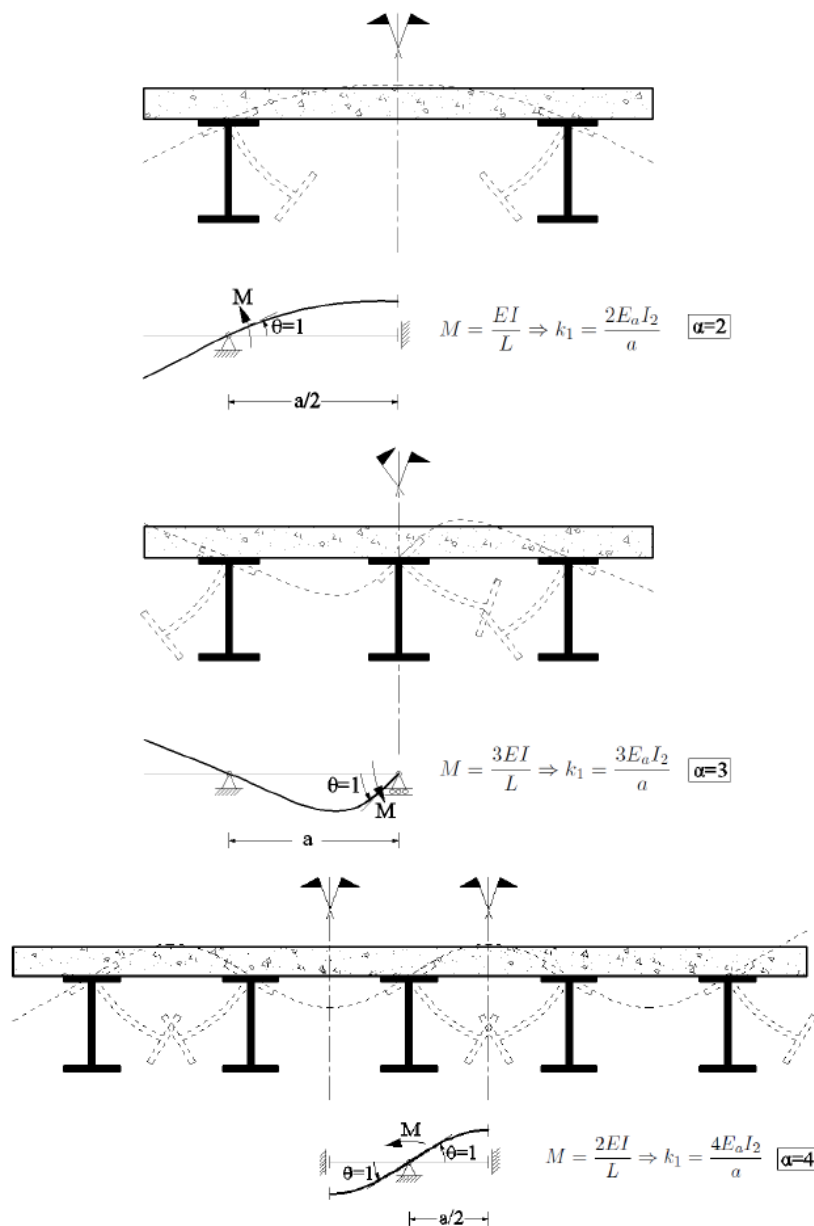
Simplificações para as condições de apoio da laje e modelos de cálculo da rigidez da laje, k_1
